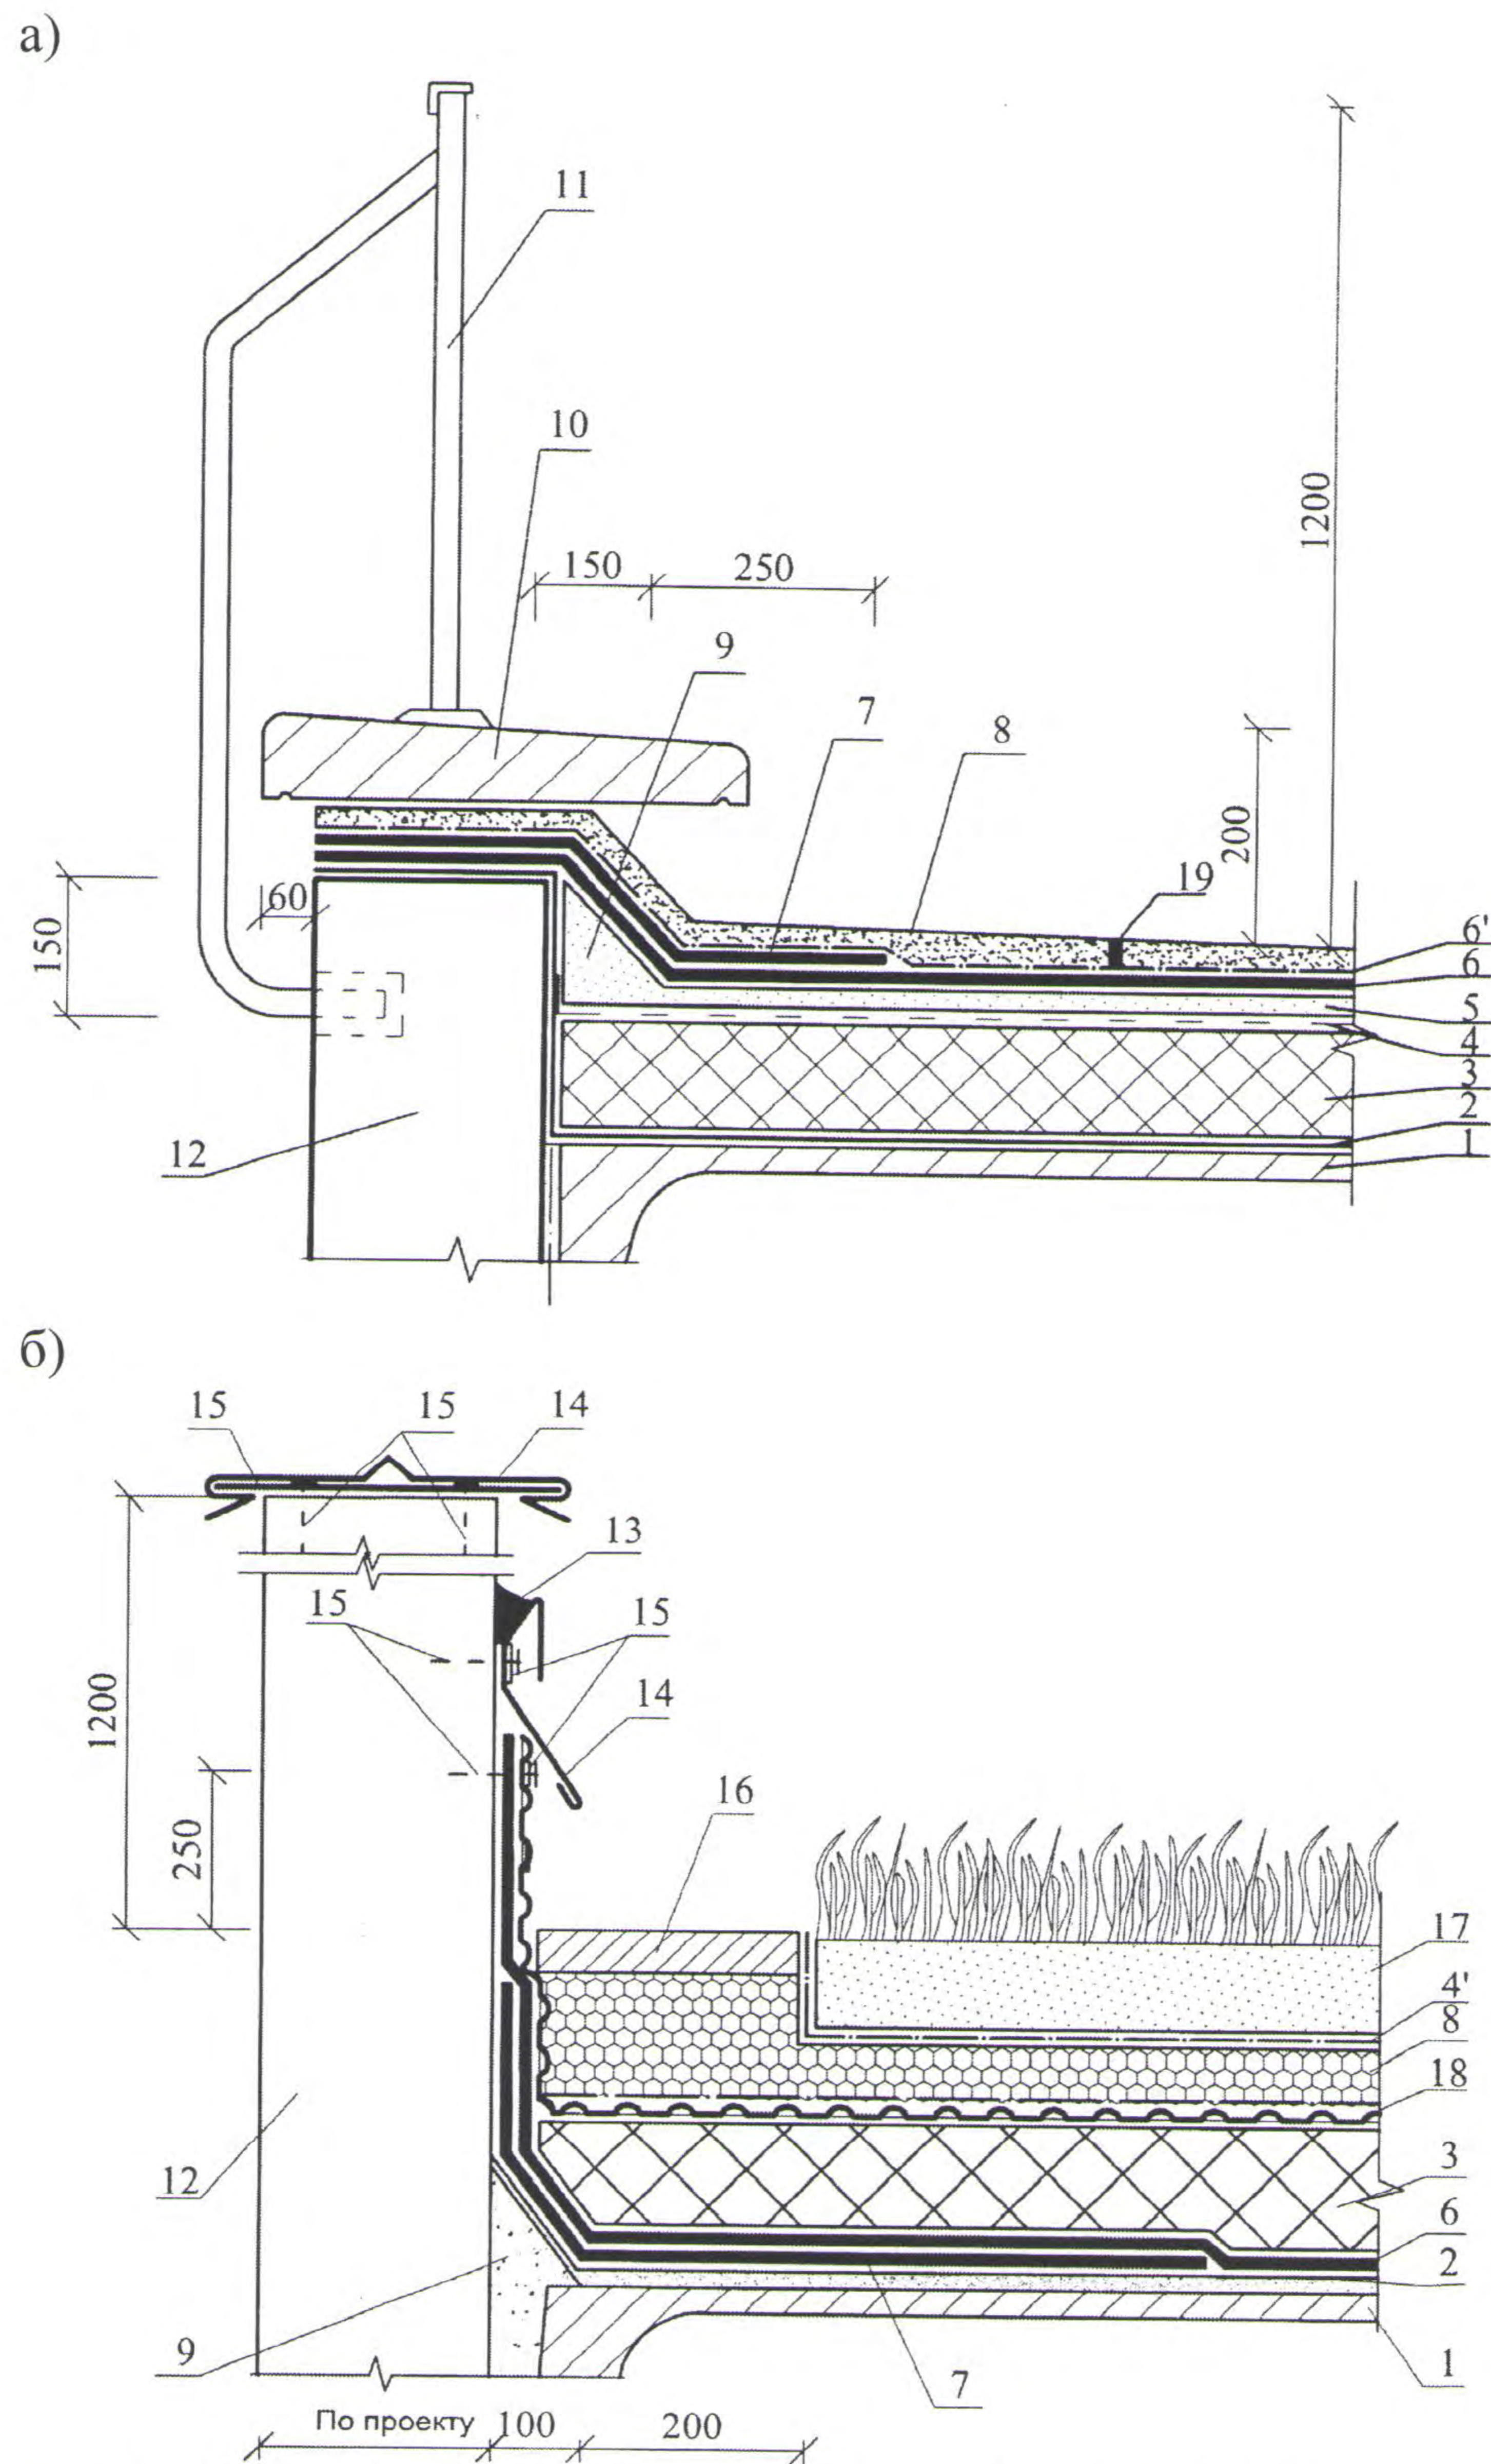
Примыкание эксплуатируемой традиционной (а) и инверсионной (б) кровли к парапету стены
